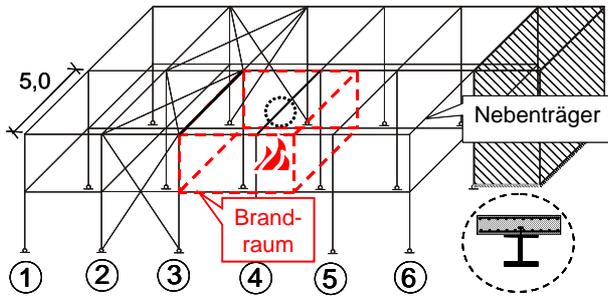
Stahlskelettkonstruktion eines Bürogebäudes mit Brandraum
